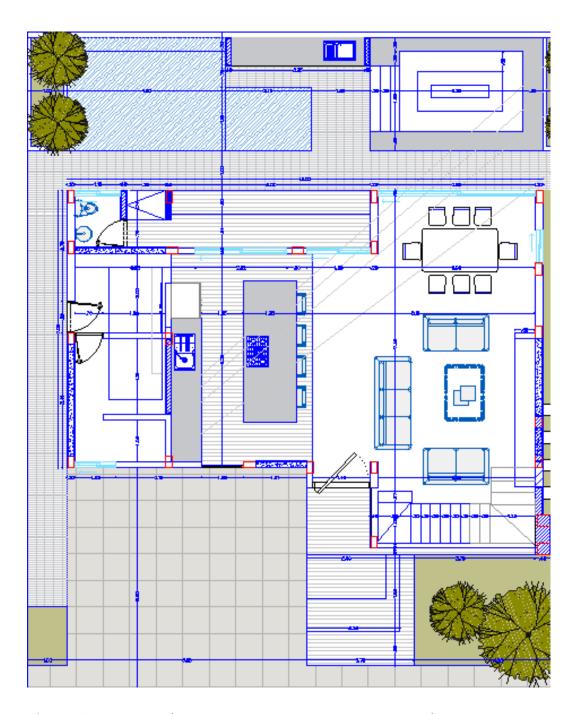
Localización de muros. Fuente: Planos arquitectónicos.
